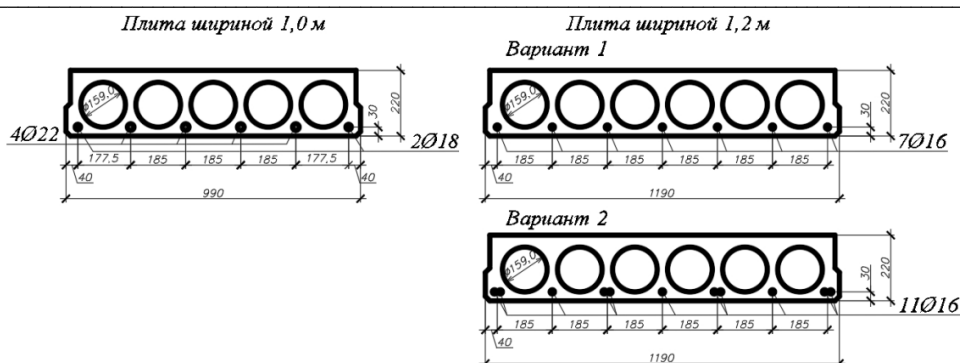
Схема армирования для плит шириной 1,0 и 1,2 м
